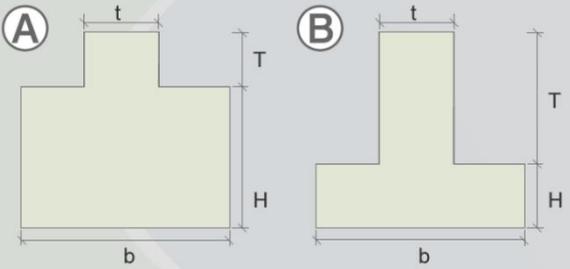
is – scheda 'Regolarità in pianta' per la tipologia 'Calcestruzzo armato'
